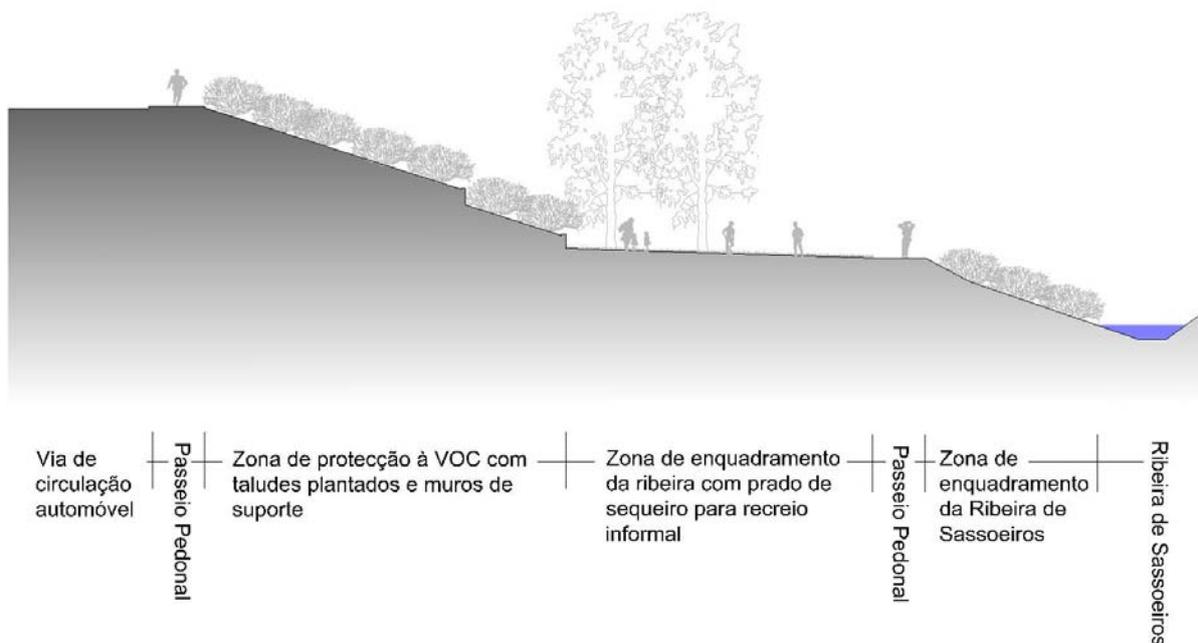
Corte Tipo P3 – Corte da zona de protecção à VOC / Zona de enquadramento da Ribeira de Sassoeiros (sem escala)
